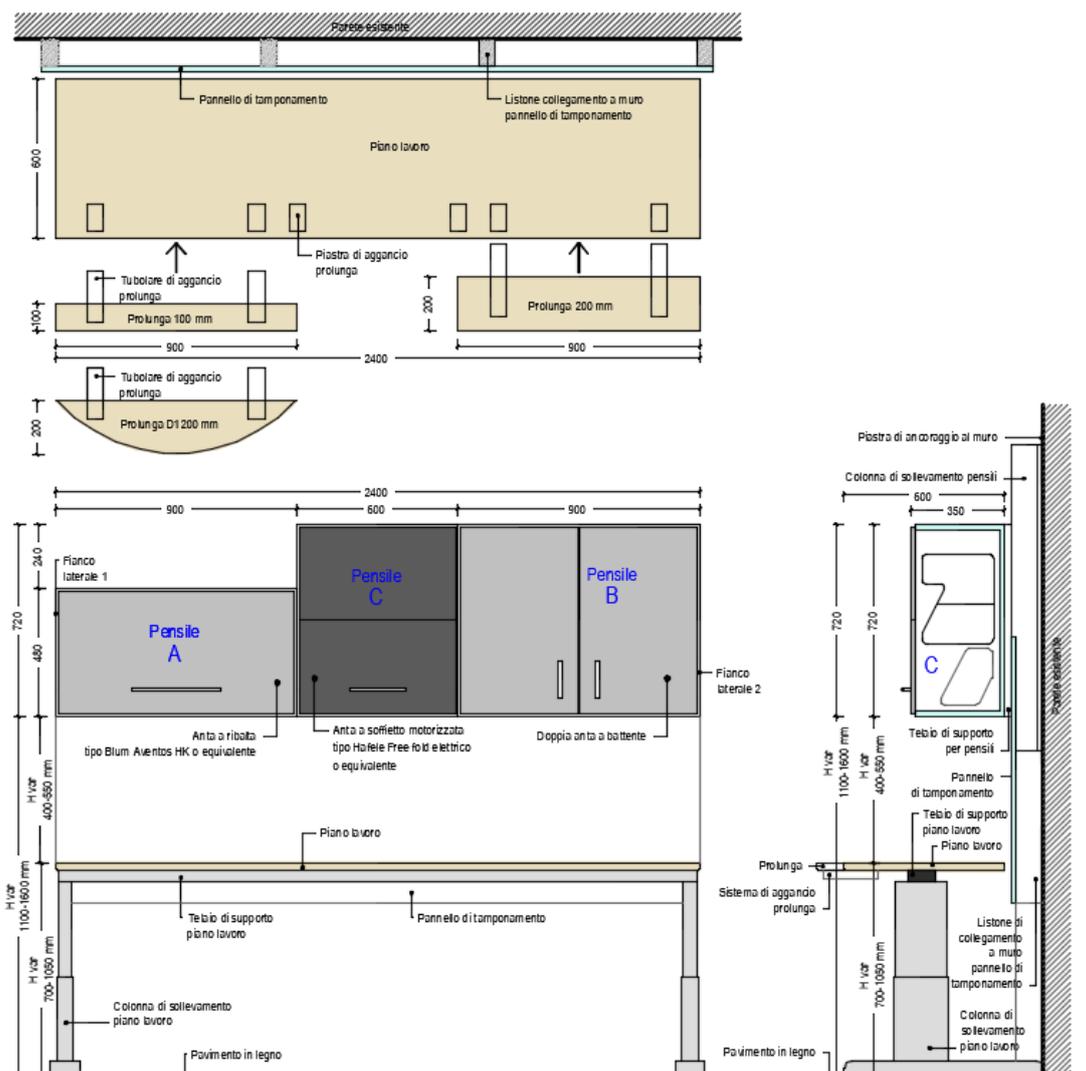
Pianta, prospetto frontale e sezione Blocco Ergonomia
